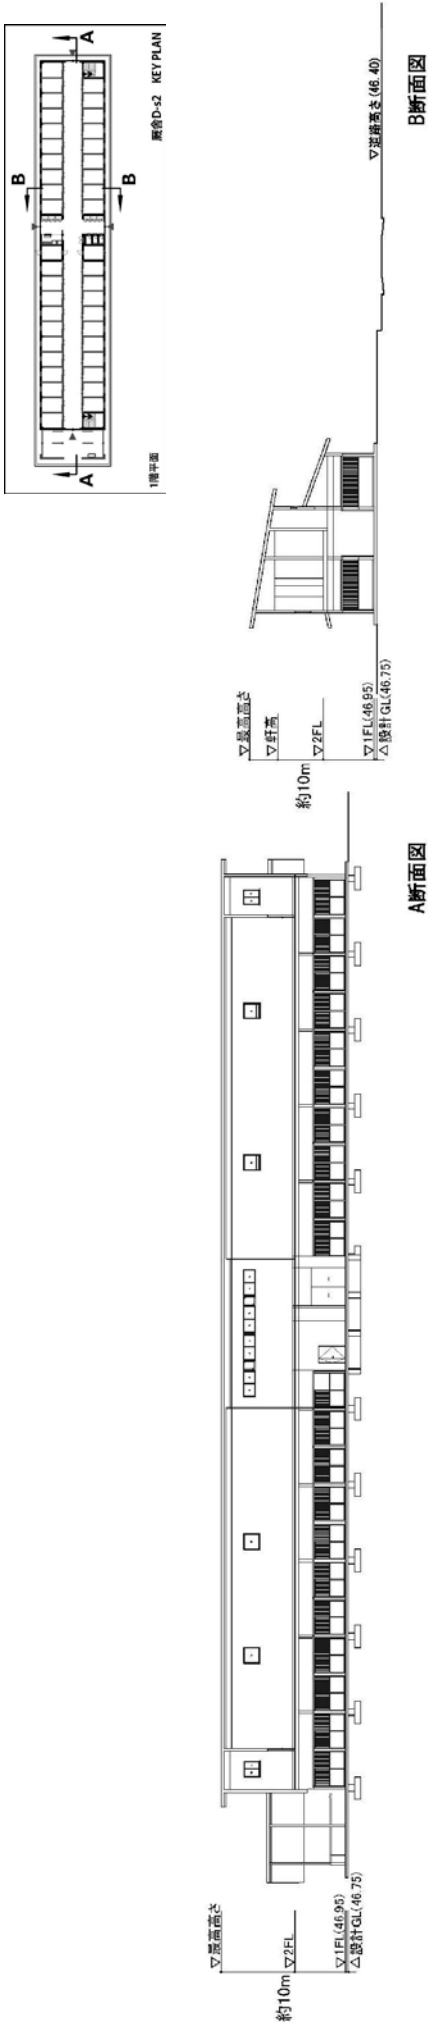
(8) 断面図 (厩舎 (D-s2))
